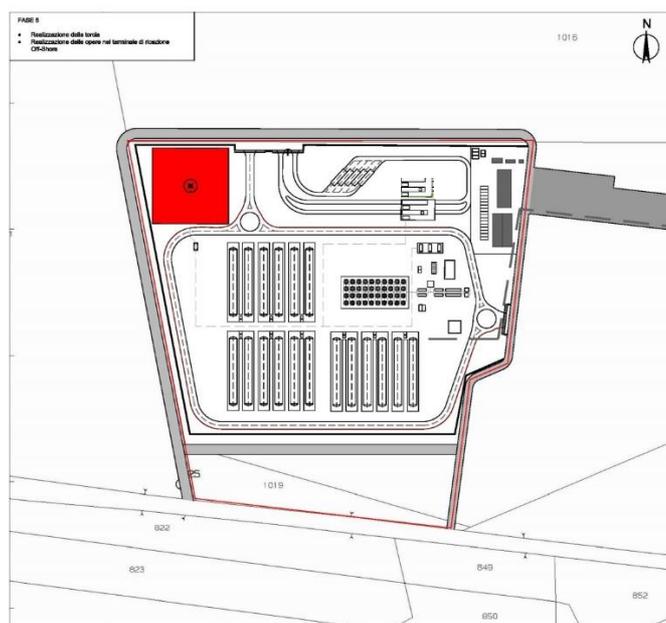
Fase 5. Area oggetto delle lavorazioni previste
